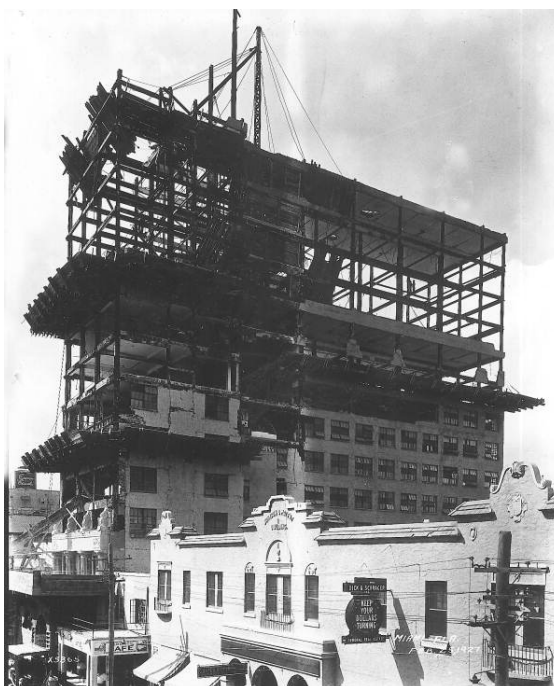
Reconstrução do Meyer-Kiser Bank Building em 1927. Fonte: [Fishbaugh \(1927\)](#)
